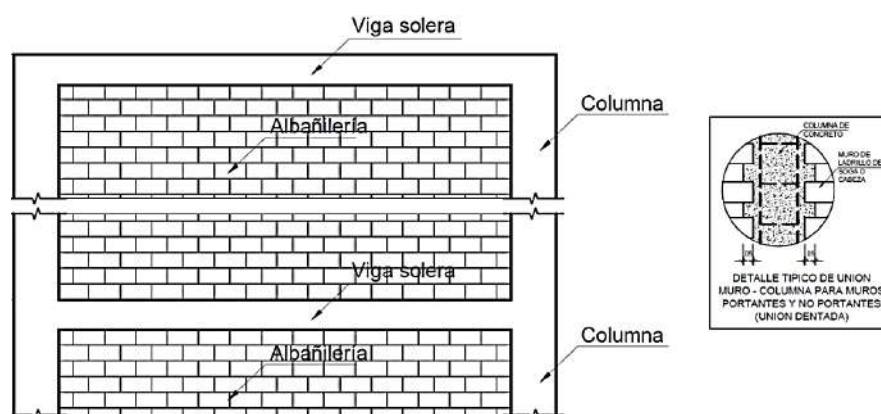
Organización del sistema resistente, edificación en albañilería confinada en todas las plantas
